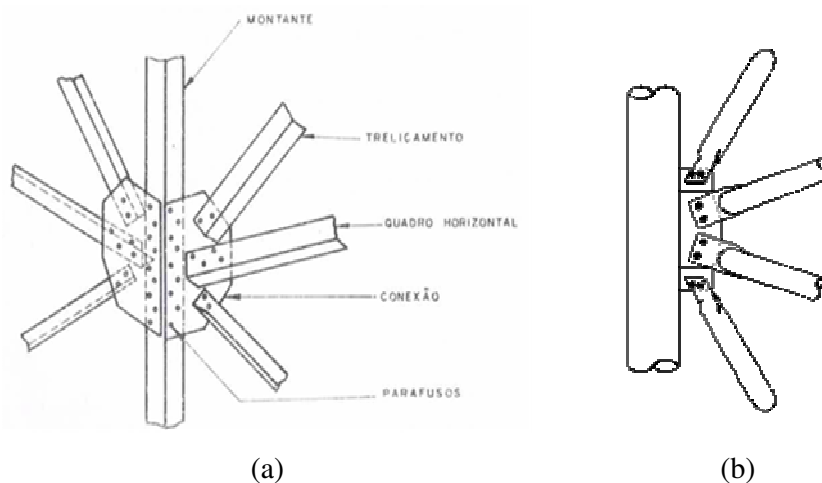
Conexões entre montante e outros membros. (a) perfil cantoneira; (b) perfil tubular.
